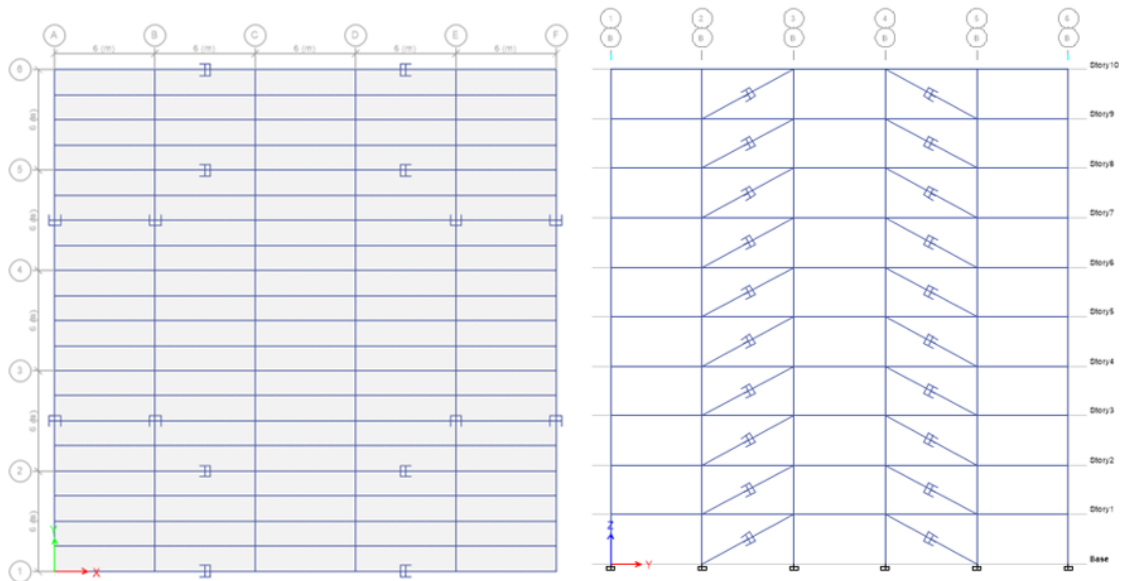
Planta y elevación de pórtico interior B de edificio de 10 pisos
